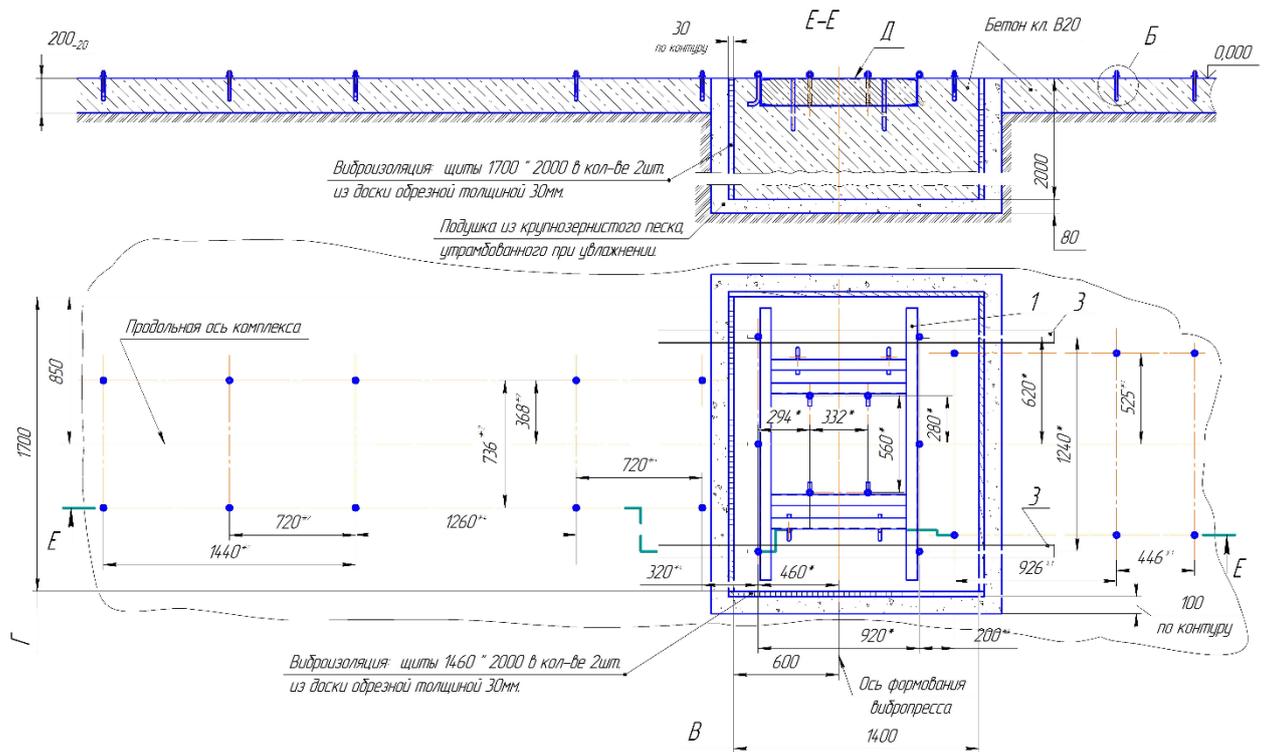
План фундамента комплекса Лидер-Цвет
